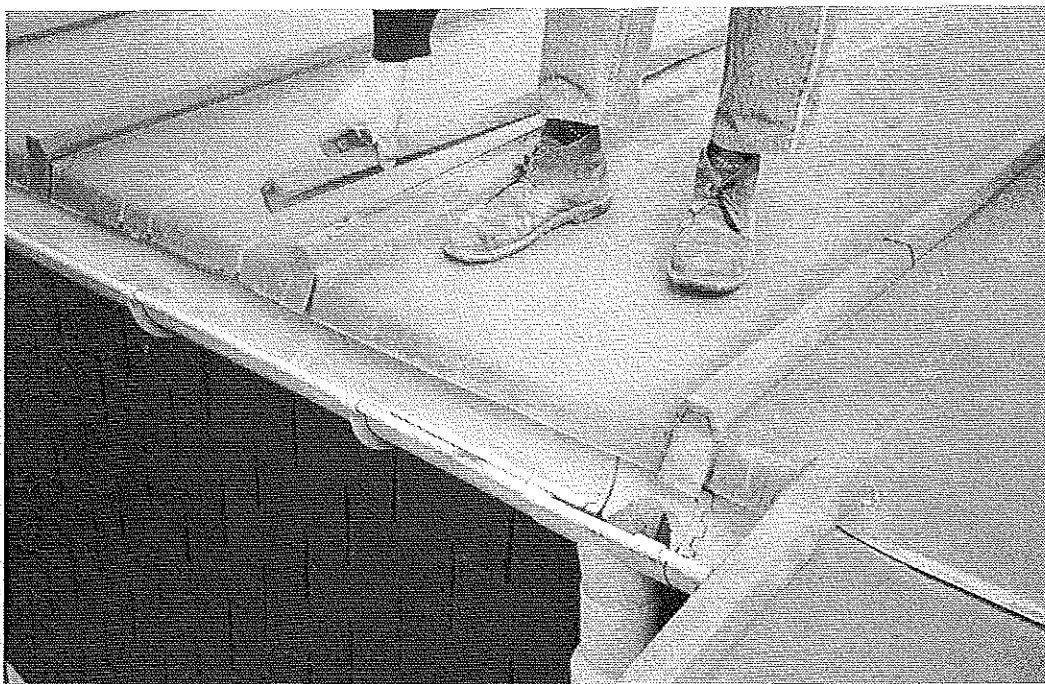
Défaut de fixation du couvre-joint de tasseau. Défaut de soudure du talon ; raccord tasseau de rive (embout). © J. Putatti
